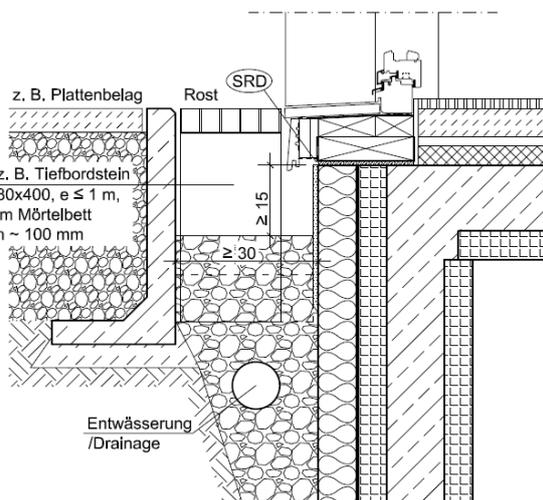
Terrasse mit Fenstertüre und Holzfassade
